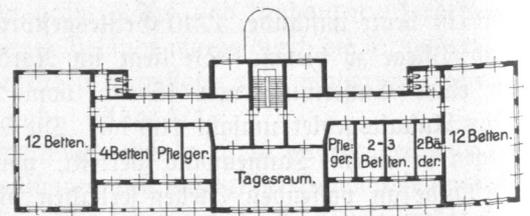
Irrenanstalt Friedrichsberg, Krankengebäude, Obergeschoss, Grundriß.
